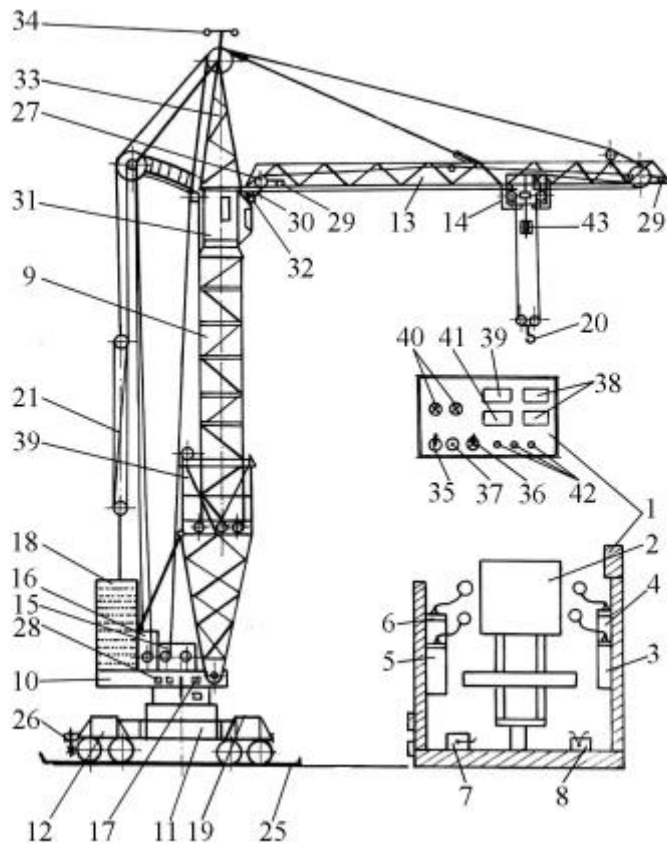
Схема крана та кабіни керування баштового крана КБ-403А
